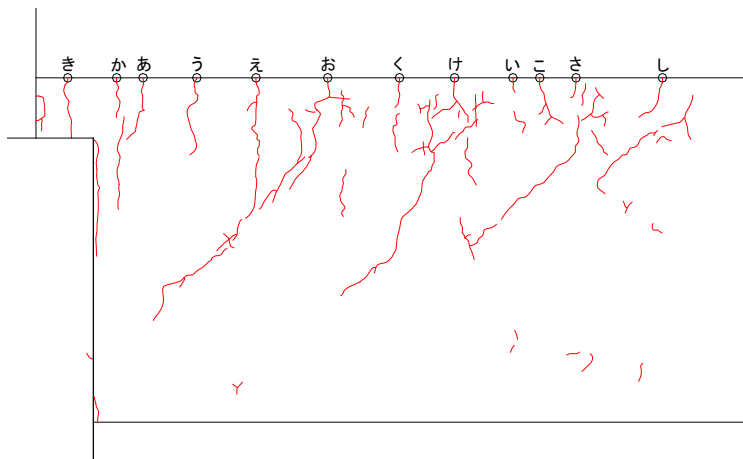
基礎梁ひび割れ幅測定位置 (試験体 A-7a 負荷荷)
